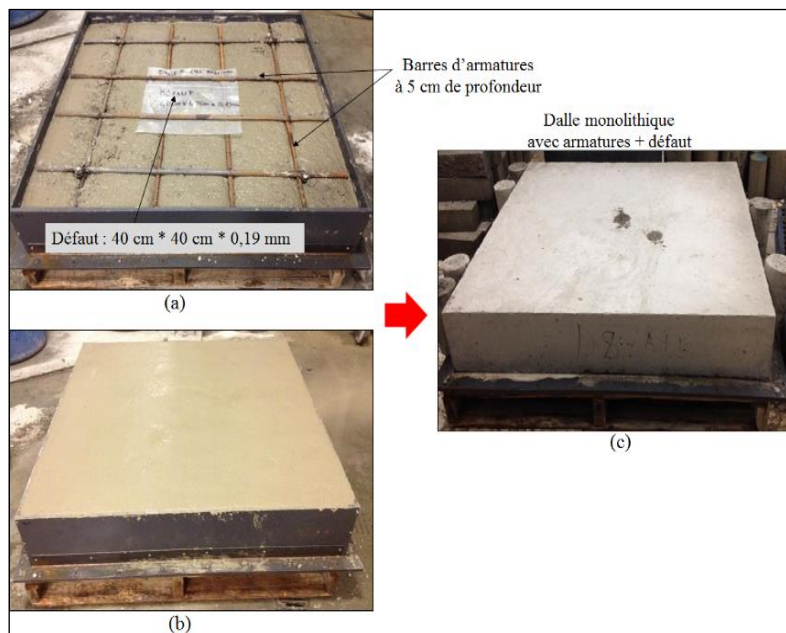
Dalle N° 8, (a) Mise en place des barres d'armature et du défaut, (b) Remplissage du moule, (c) Dalle monolithique finale.
